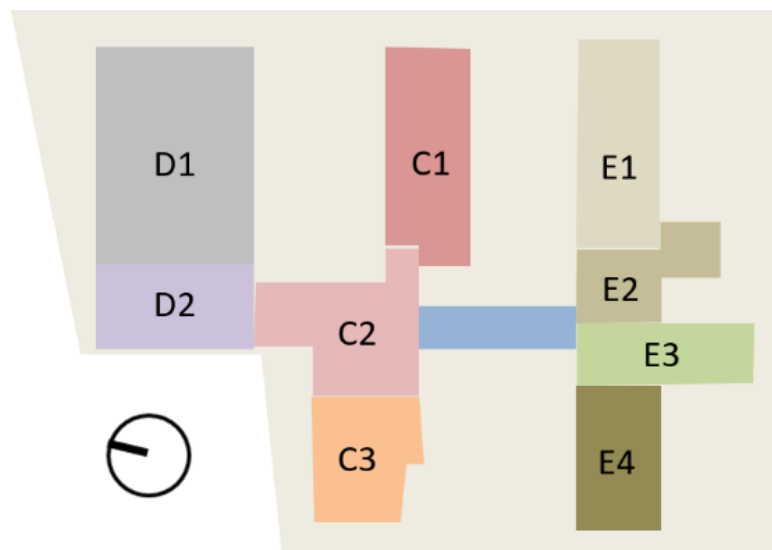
Disposición de bloques en el Proyecto de Tesis. Elaboración propia.
